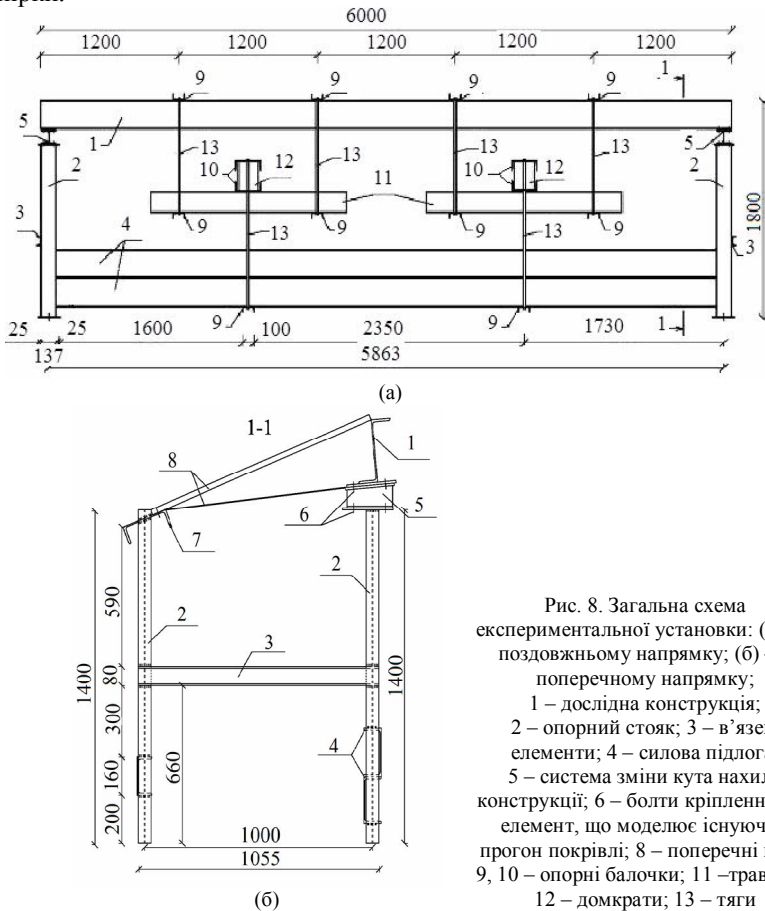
Загальна схема експериментальної установки: (а) – у поздовжньому напрямку; (б) – у поперечному напрямку; 1 – дослідна конструкція; 2 – опорний стоек; 3 – в'язеві елементи; 4 – силова підлога; 5 – система зміни кута нахилу конструкції; 6 – болти кріплення; 7 – елемент, що моделює існуючий прогон покрівлі; 8 – поперечні в'язі; 9, 10 – опорні балочки; 11 – траверси; 12 – домкрати; 13 – тяги
